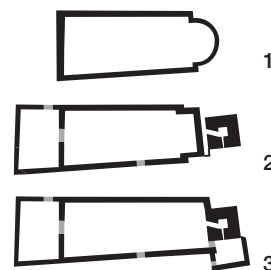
Ringgenberg, Kirchenruine Goldswil. Rekonstruierte Grundrisse der Bauphasen. 1 Saalkirche, 10.–12. Jahrhundert; 2 Saalkirche mit Narthex und Campanile 11.–16. Jahrhundert; 3 Kirche nach 1528–1670. M. 1:1000.
